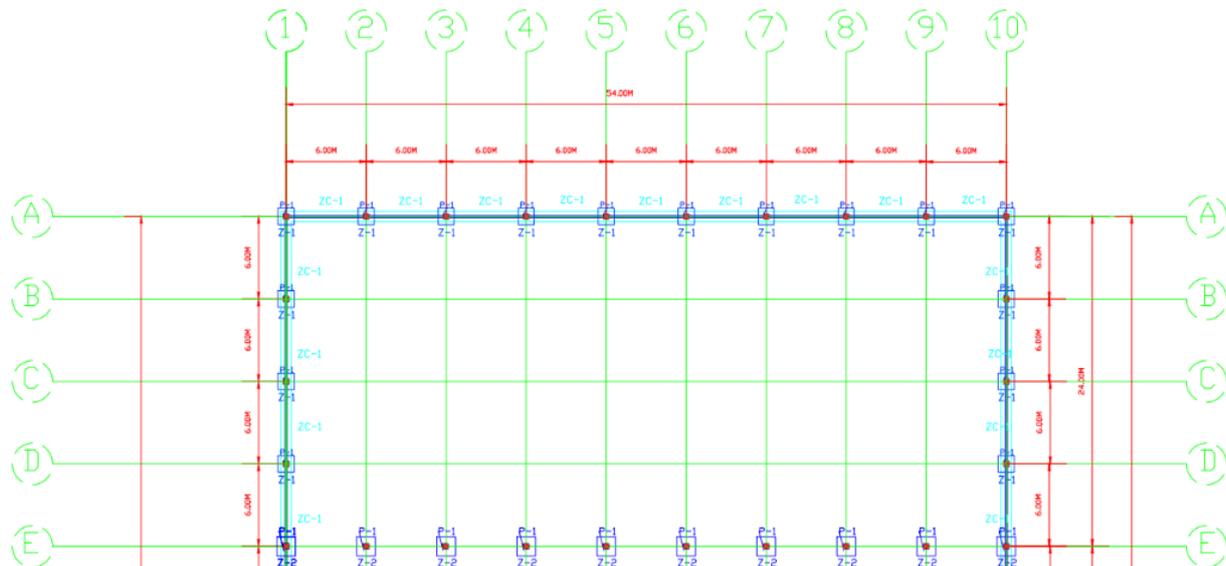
Ubicación Zapatas Z-1 en Nave 1
